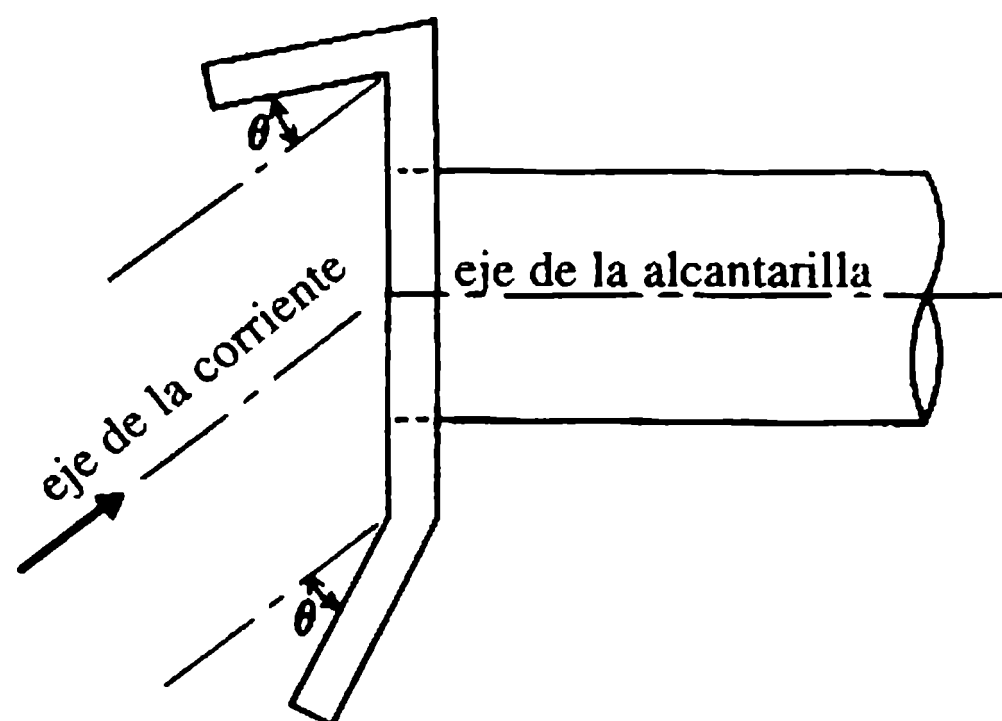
Estructuras de entrada de alcantarillas; vistas en plantas.
